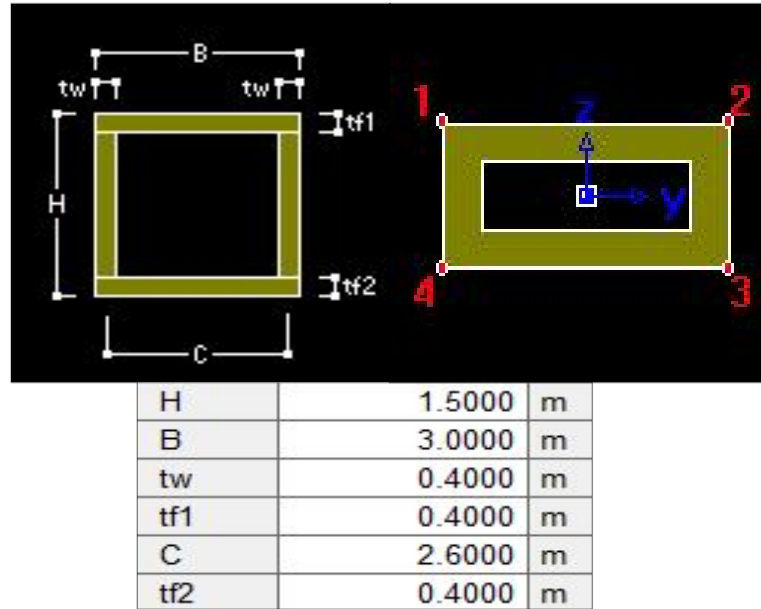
Sección transversal rectangular hueca de la pila central.
